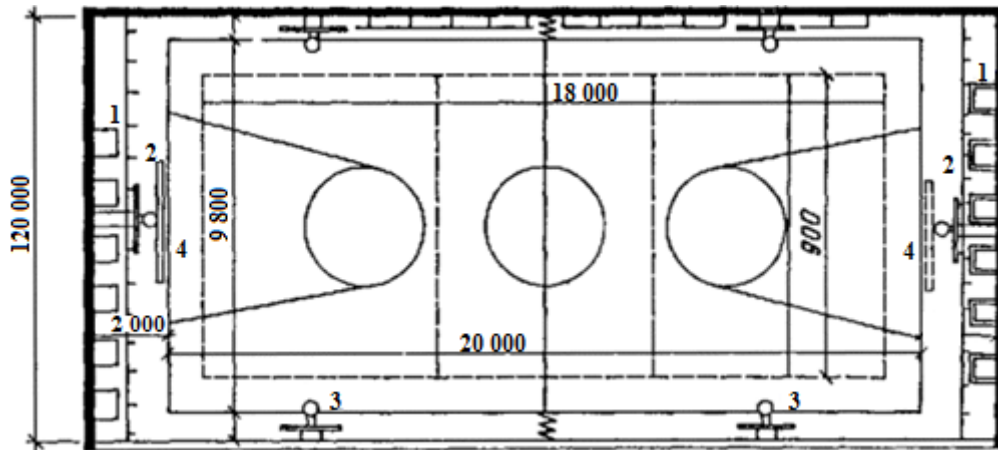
Варіант розташування обладнання в залі фізичної підготовки
